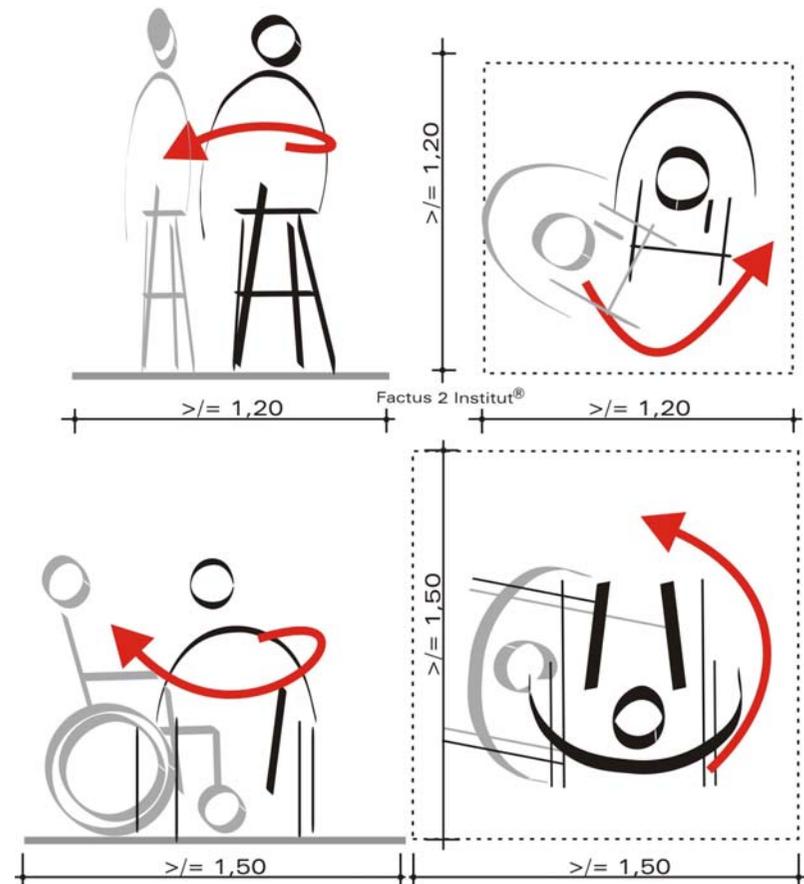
© Factus 2 Institut® Geometrische Bewegungsflächen (oben) für barrierefreie Wohnungen (unten) für rollstuhlgerechte Wohnungen und für alle allgemein zugänglichen Bereiche (z. B. Treppenhaus, Flure u. A.)
